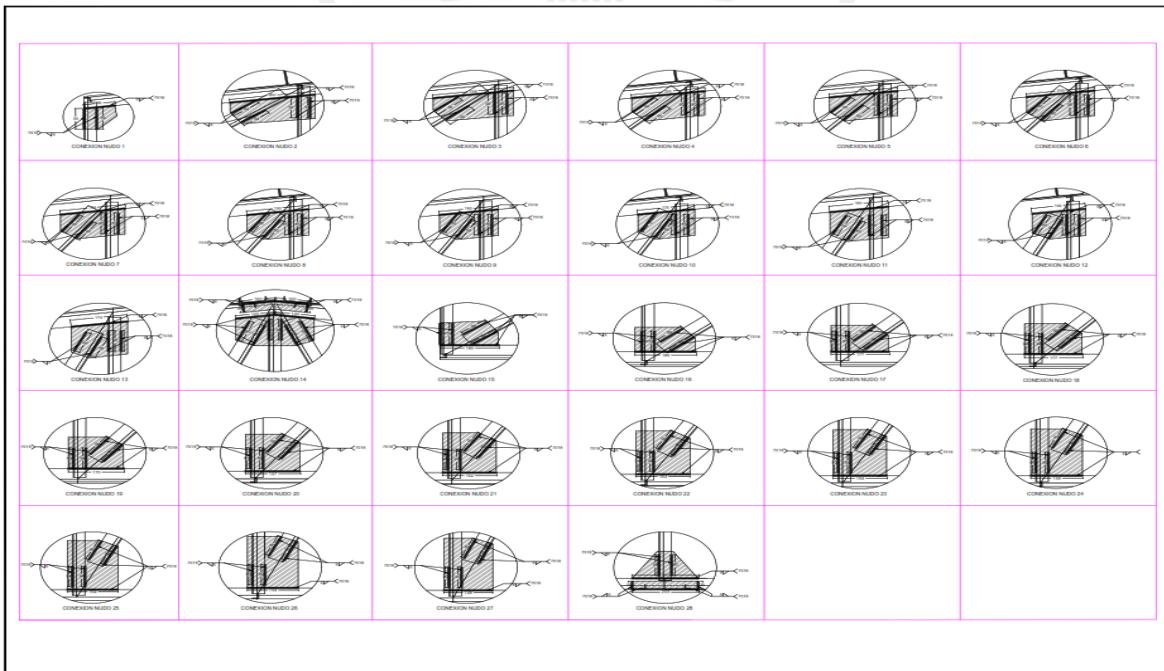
Diseño Estructural de Cubierta a Instalar
